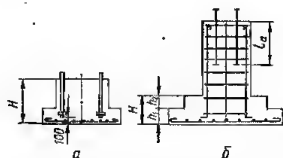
Монолитные фундаменты под стальные колонны:
